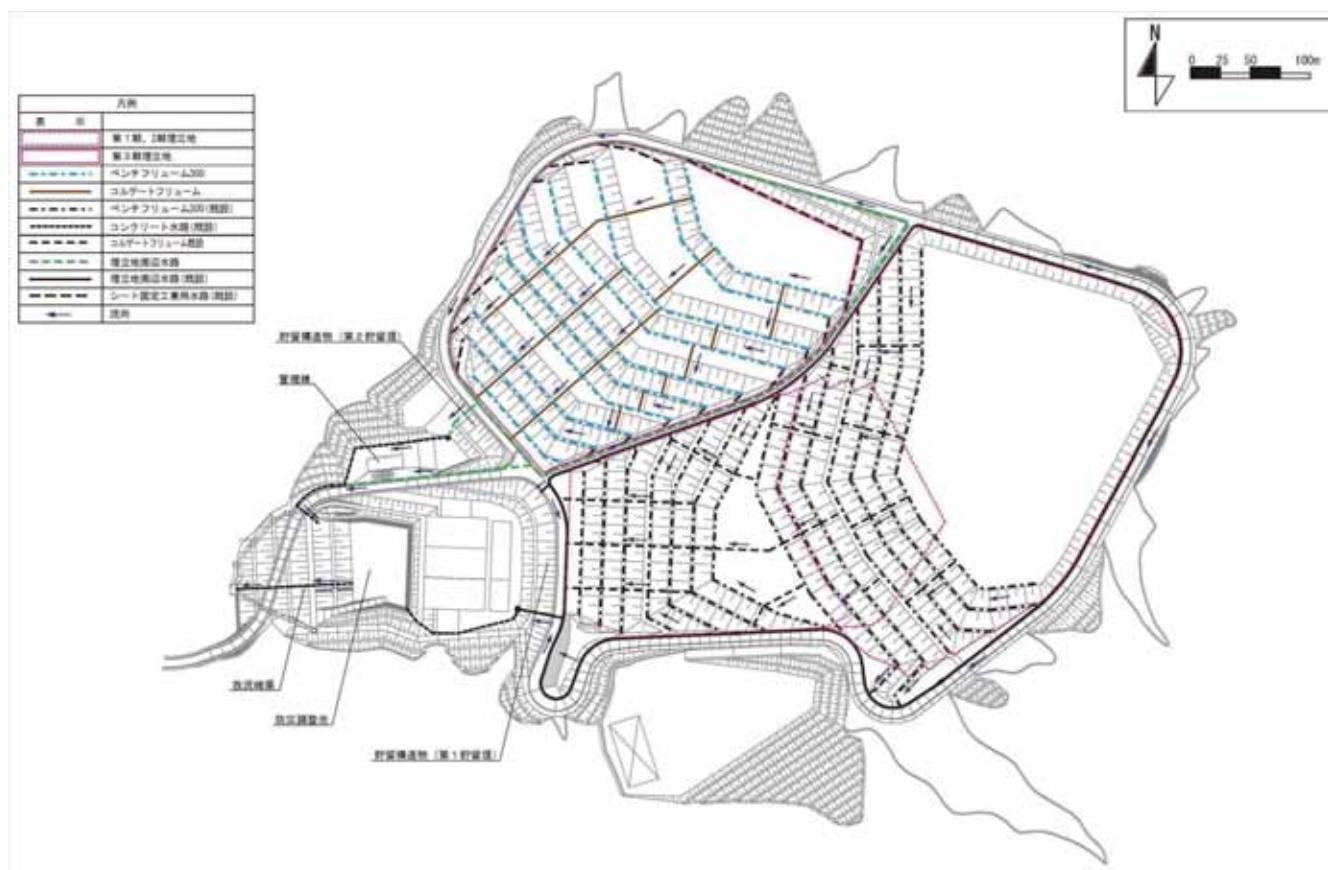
雨水集排水施設配置図 埋立終了時（第3期整備）
